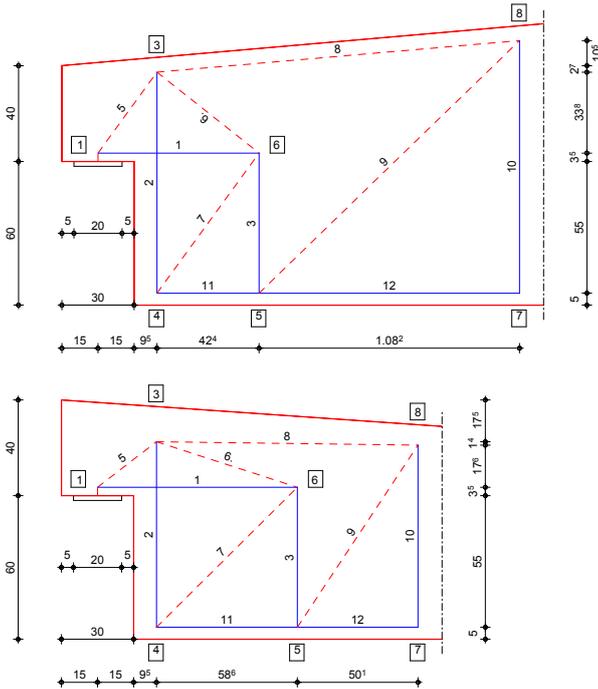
Fachwerk bei ansteigender und fallender Trägeroberkante
